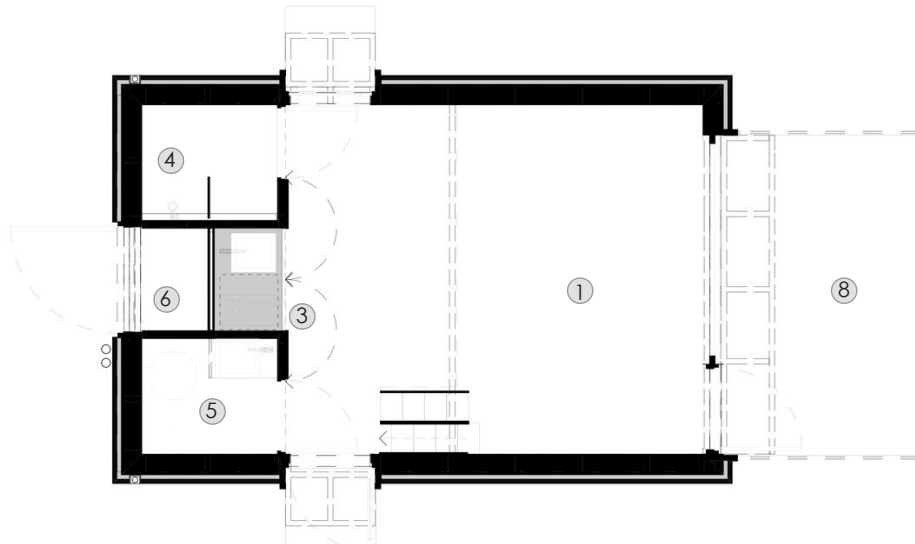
Planta baja. Fuente: ArchDaily, 2020
